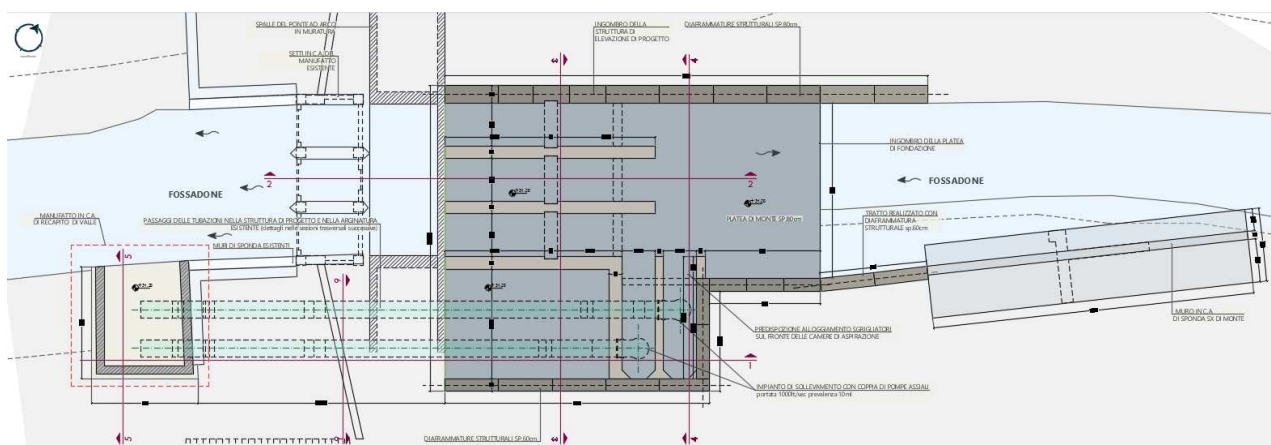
Organizzazione delle strutture di elevazione – Struttura principale di compartimentazione e regolazione
